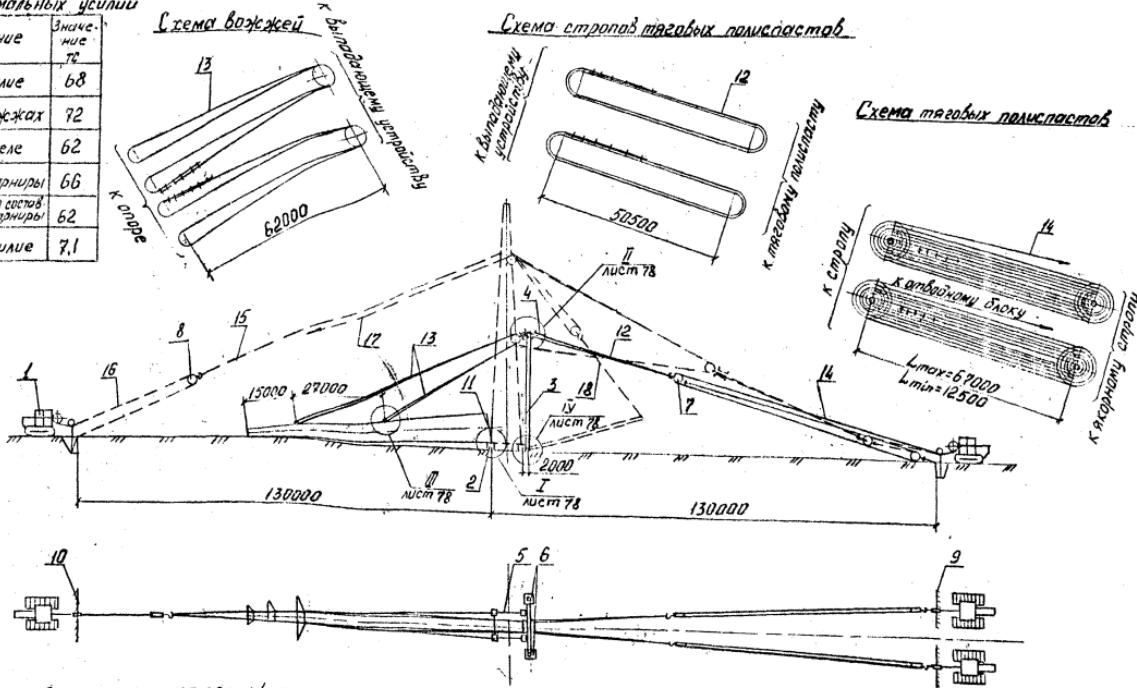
Схема подземной опоры ПП 220-1/59
